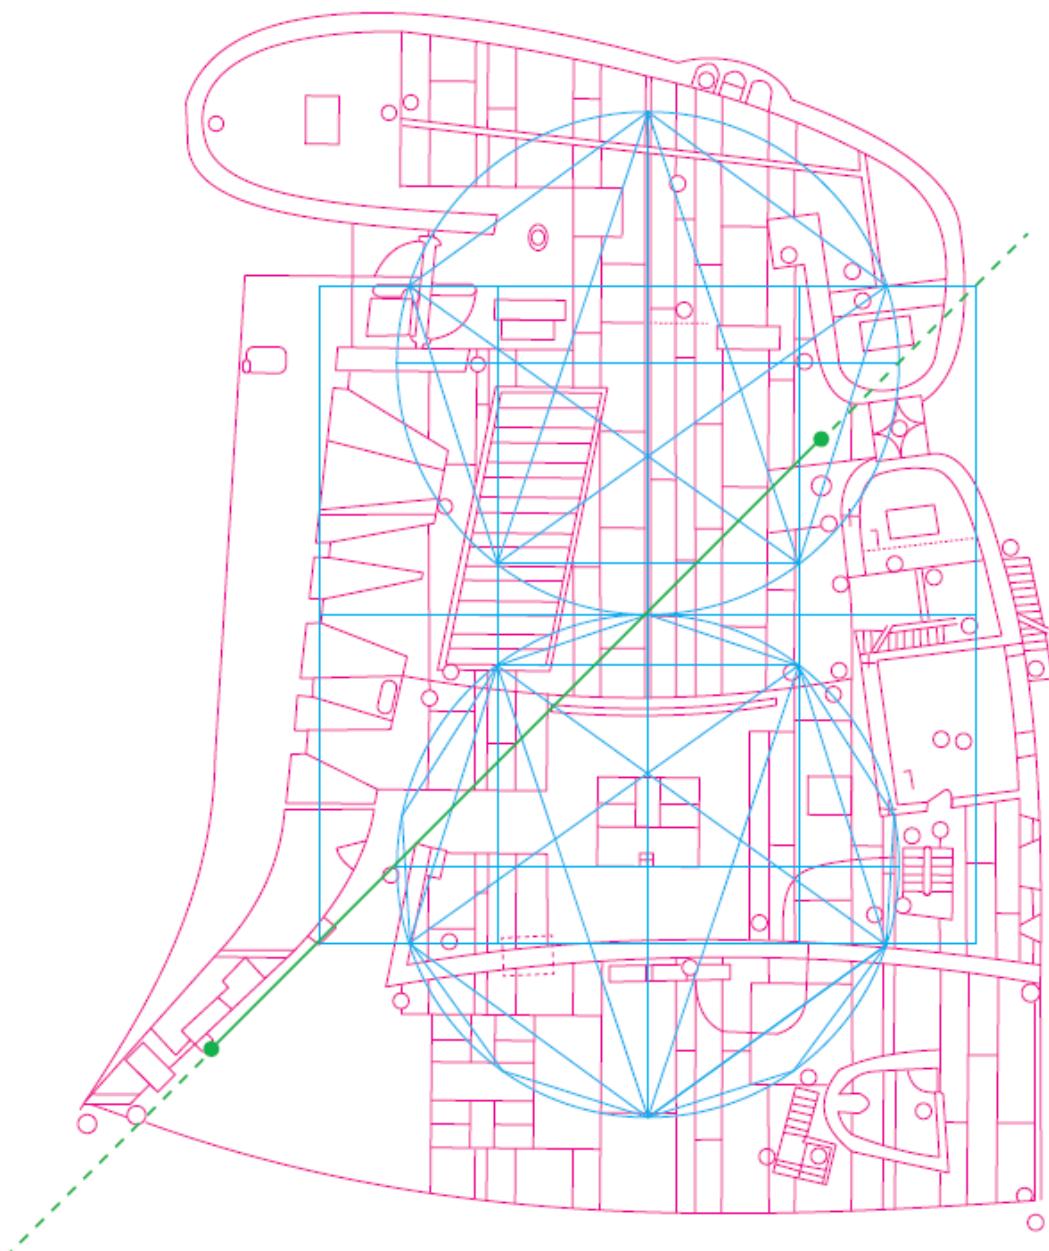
Planimetria di Ronchamp con la sovrapposizione del tracciato regolatore e dello schema geometrico del Tabernacolo degli Ebrei.
